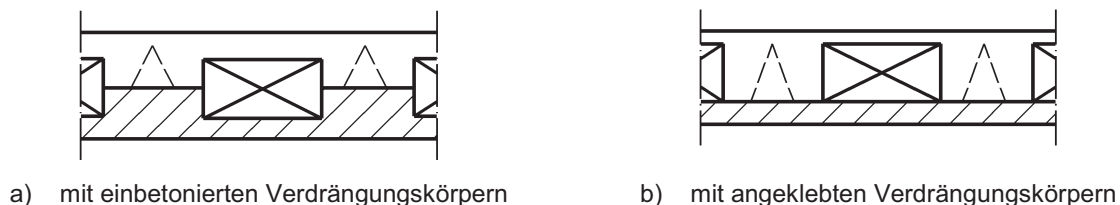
Beispiele für Hohlverbundplatten mit Ortbetonerfüllung
